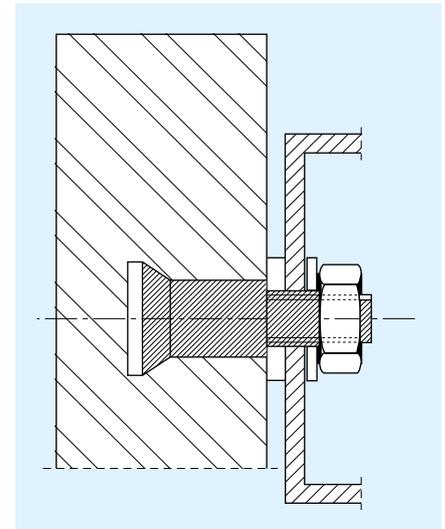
Nicht sichtbare Befestigung in den Bekleidungsplatten mit Hinterschnittdübeln
